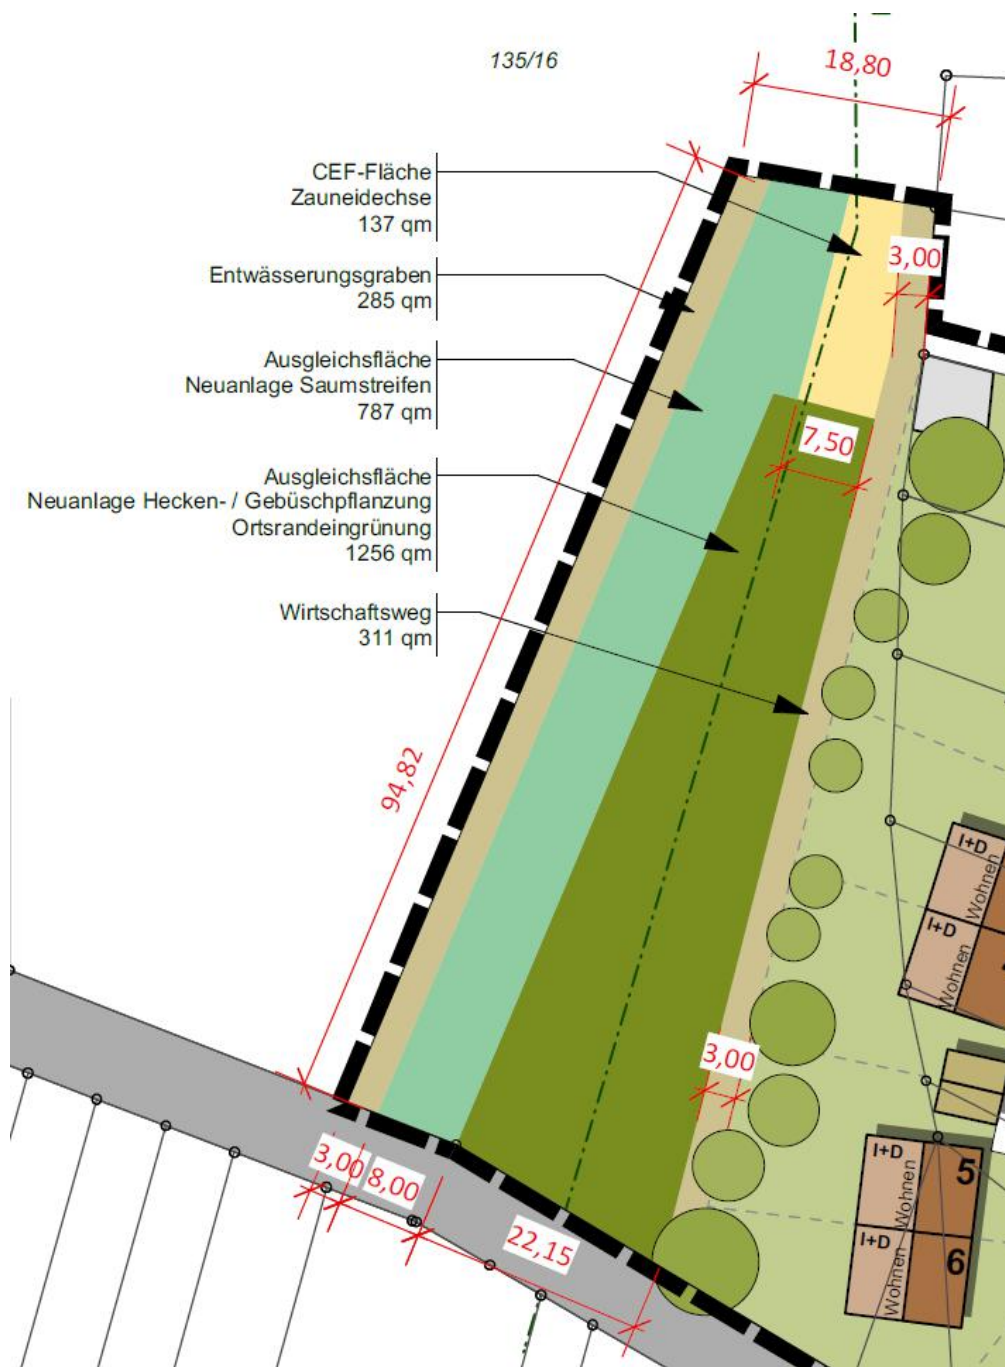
Lage und Abmessungen der Ausgleichsmaßnahmen im Westen des Bebauungsplans „Butterstadt West“ (abgestimmt mit Kaczmarek 2017).
